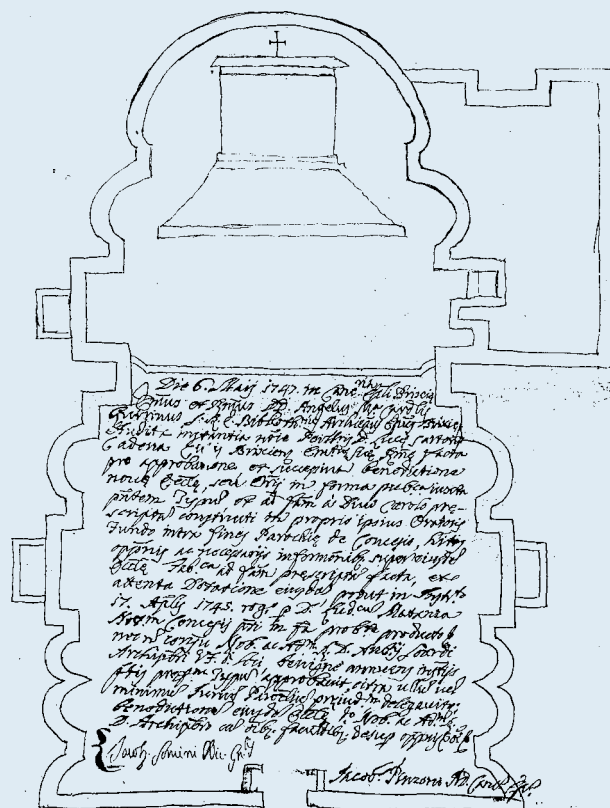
Progetto della pianta del tempietto. Tale progetto fu rispettato solo parzialmente.
